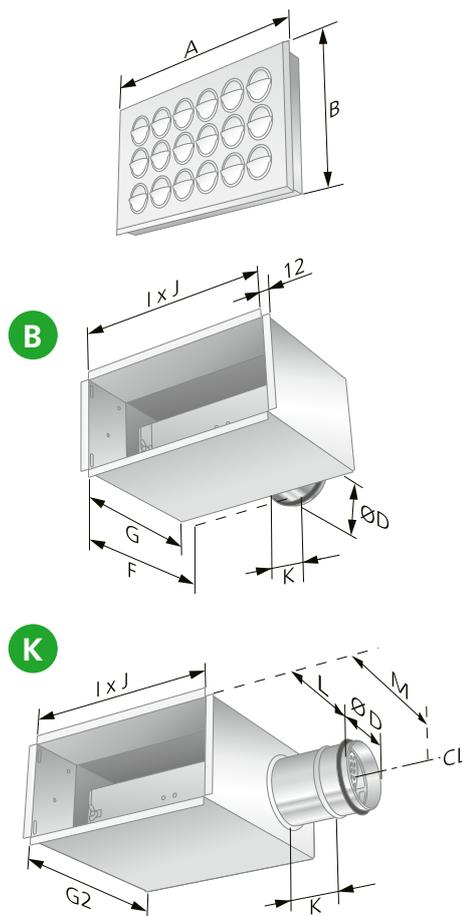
Abmessungen, COLIBRI Wall und Anschlusskasten ALV.
